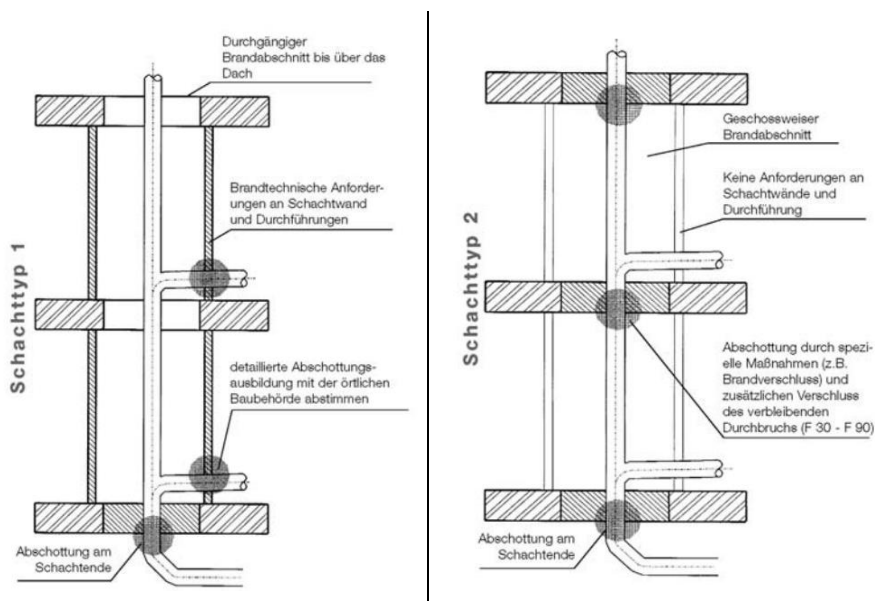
Schachtausbildung: Brandbeständige Schachtwände (links) und geschosswise Brandabschottung (rechts)<sup>79</sup>
